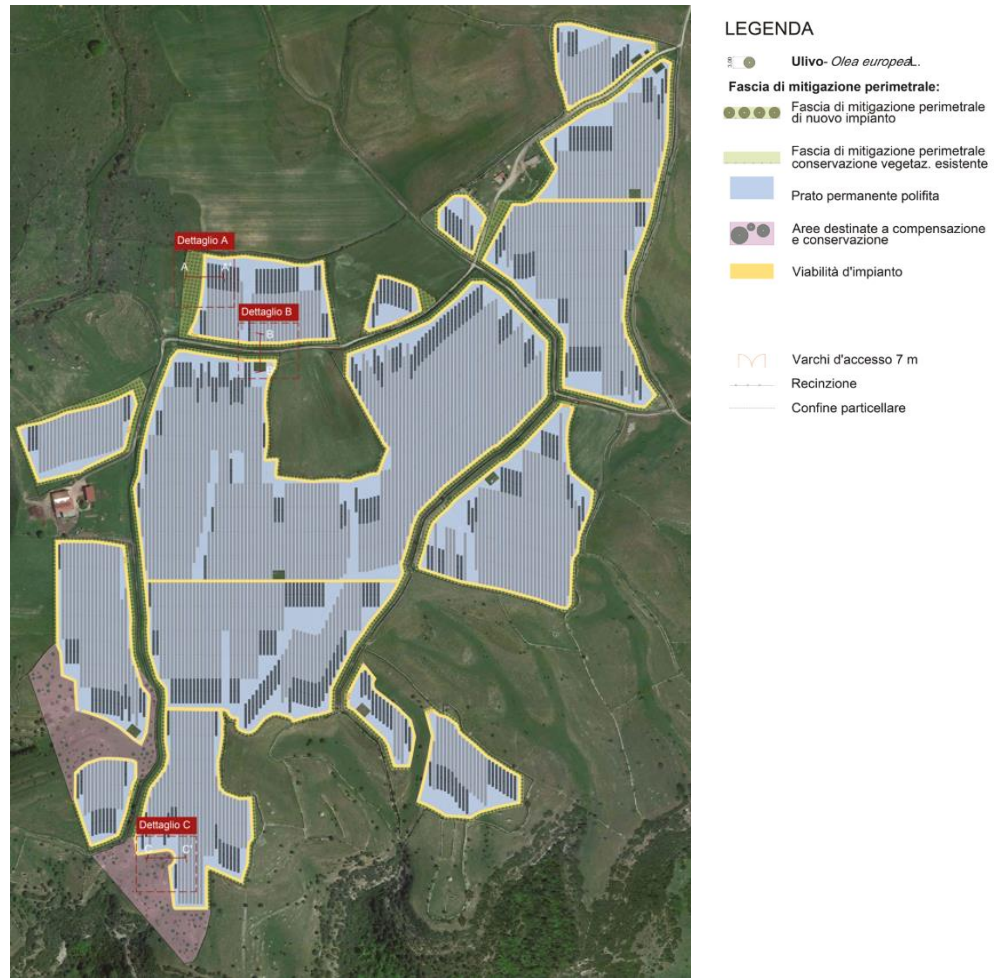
PLANIMETRIA SISTEMAZIONE A VERDE OPERE DI MITIGAZIONE (ESTRATTO DALL'ELABORATO GRAFICO SIL-PDT11)
